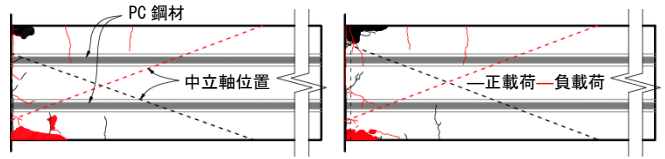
ひび割れ状況と中立軸位置の推定値
